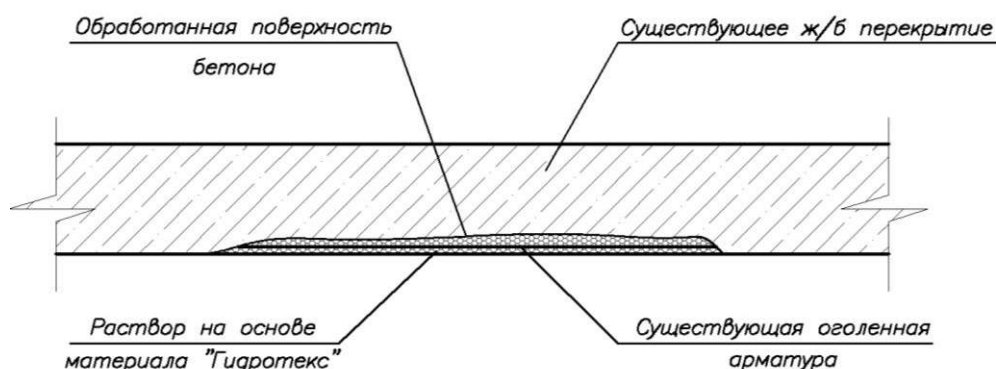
Восстановление защитного слоя бетона железобетонного перекрытия или покрытия с оголенной арматурой.
